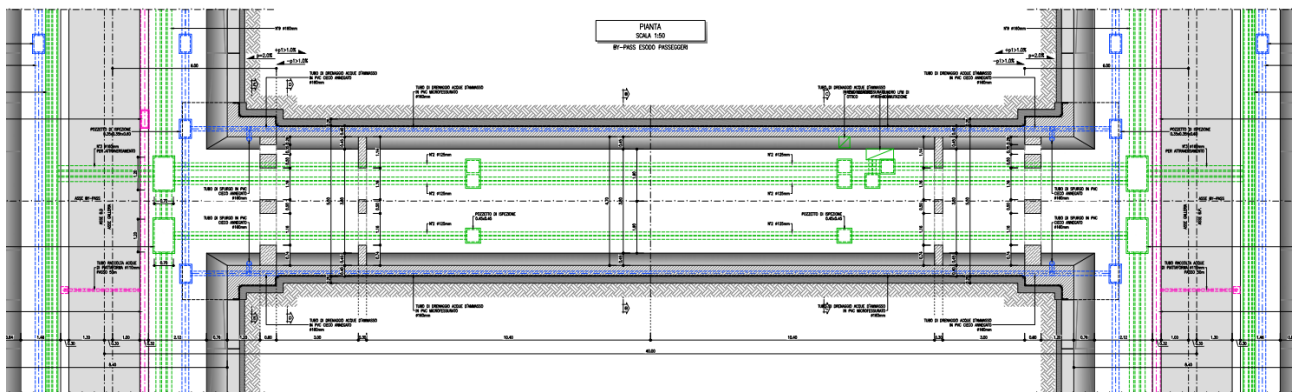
Pianta drenaggio acque di drenaggio by-pass
